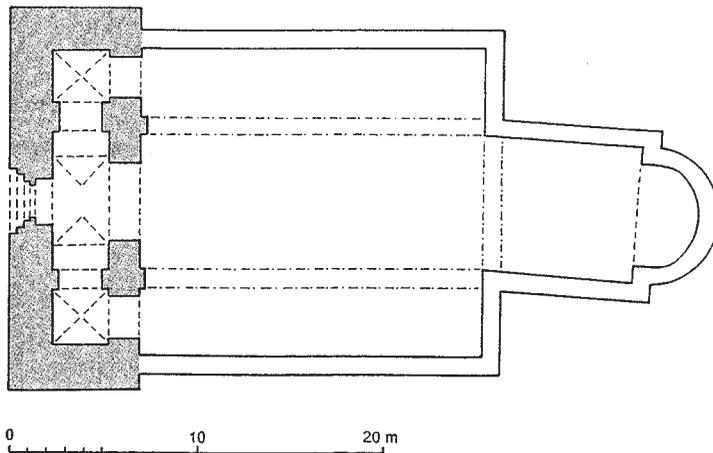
Geithain, Nikolaikirche, Grundriss der Westturmanlage mit Rekonstruktion von Langhaus und Chor, M 1:400
